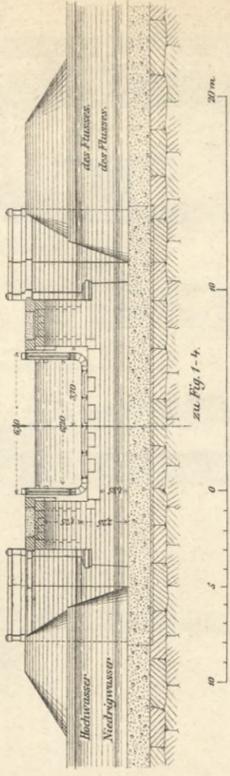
Querschnitt der Eisenconstruction. Cross-section of the iron construction, showing the structural details of the iron frame.
